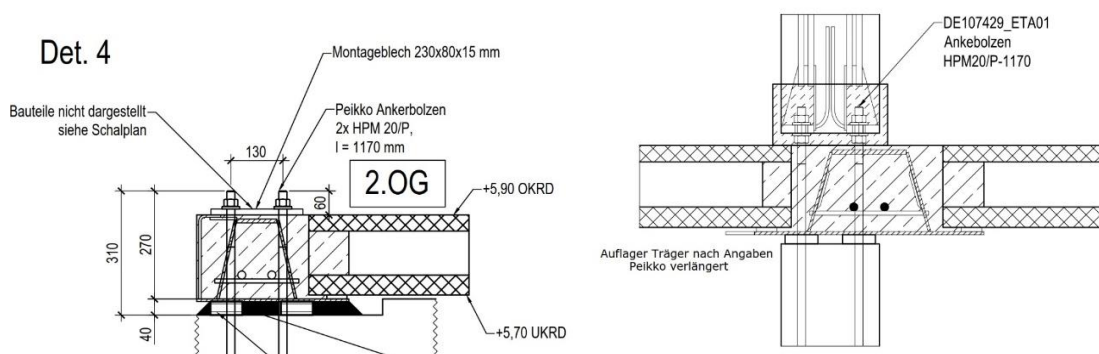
Detail - Anschlusspunkt Stahlbeton-Fertigstütze, Stahlverbundträger (Peikko) als Randträger und Spannbeton-Hohlplattendecke, [DW Systembau GmbH]
